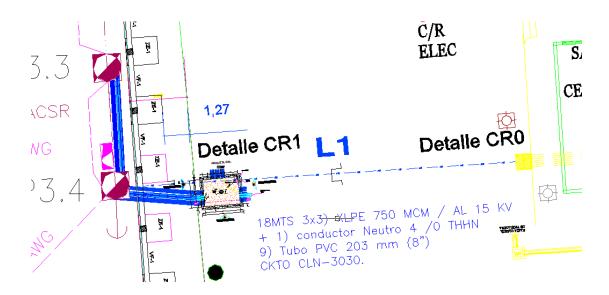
Ejemplo de diseño soterrado-Auto CAD Fuente: Criterios para construcción de redes soterradas DN-DS.
